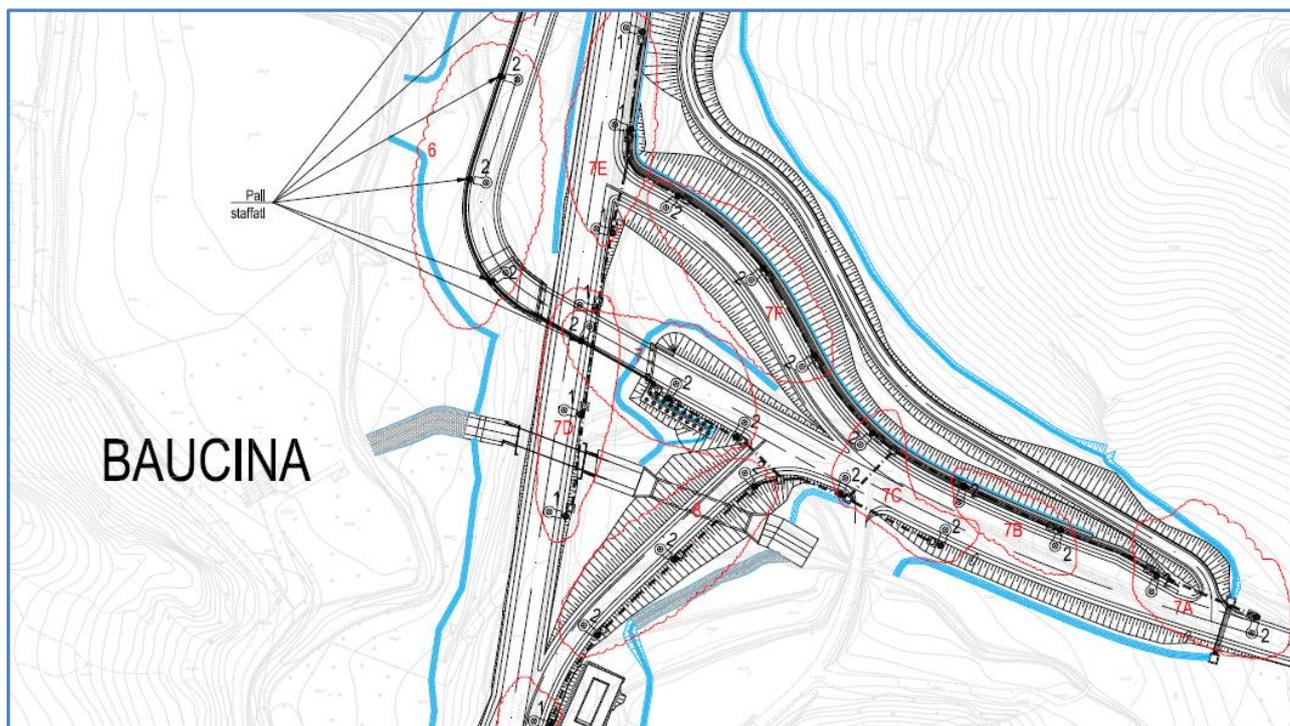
Stralcio planimetrico di P.V.T.2 dell'impianto di illuminazione Svincolo Baucina – codifica elaborato PEIEB006_50_4137, PEIEB007_50_4137.
